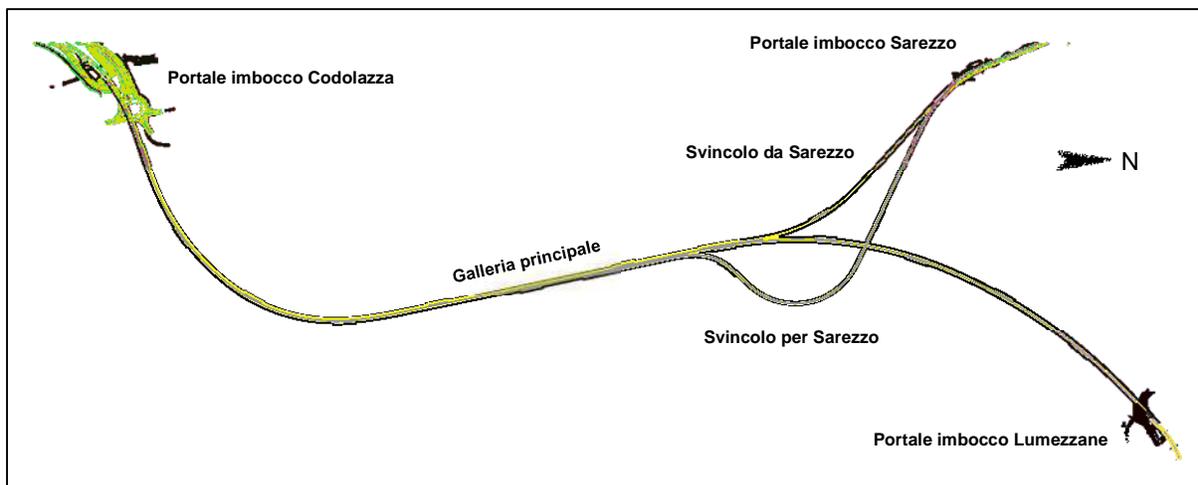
Schema planimetrico galleria Villa Carcina
